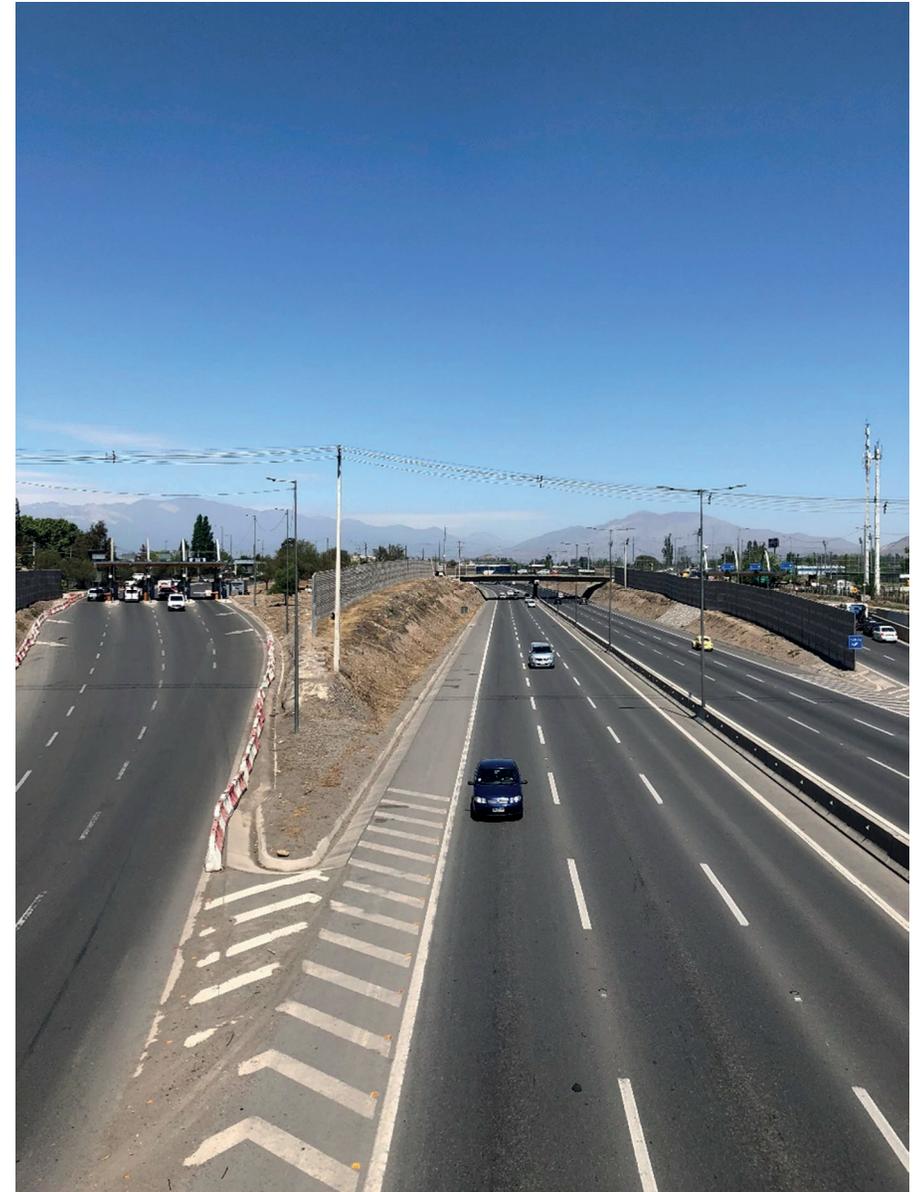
Acceso Sur. Salida Gabriela. Puente Alto. Fuente E Autor (2019).
